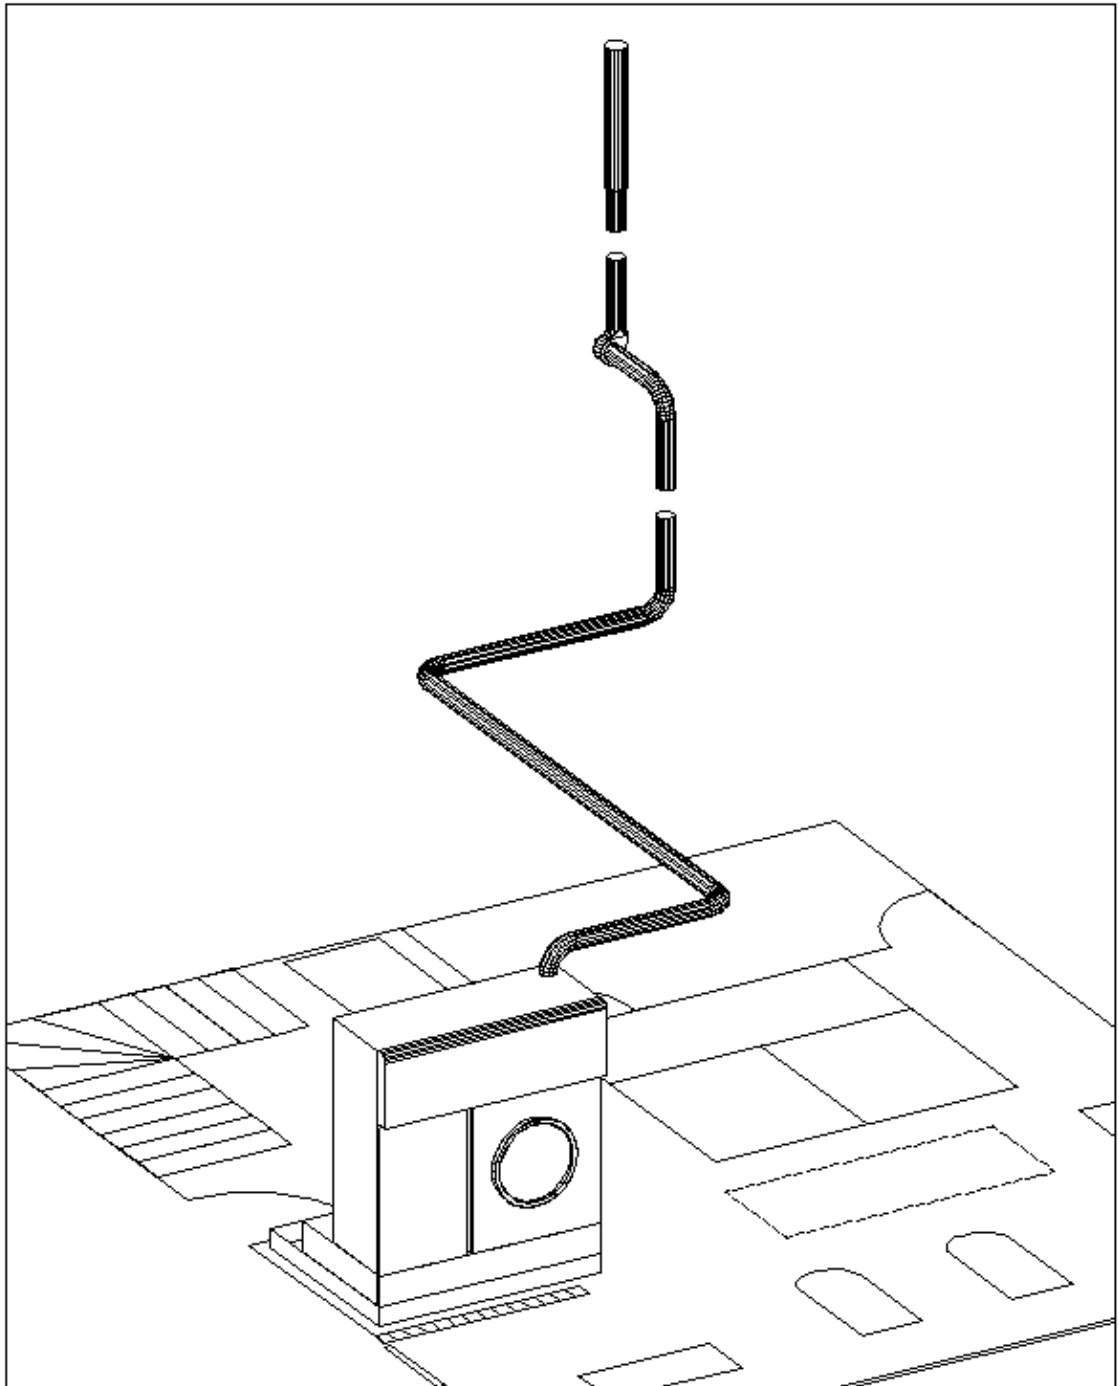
Sistema de descarga extracción puerta de máquina
